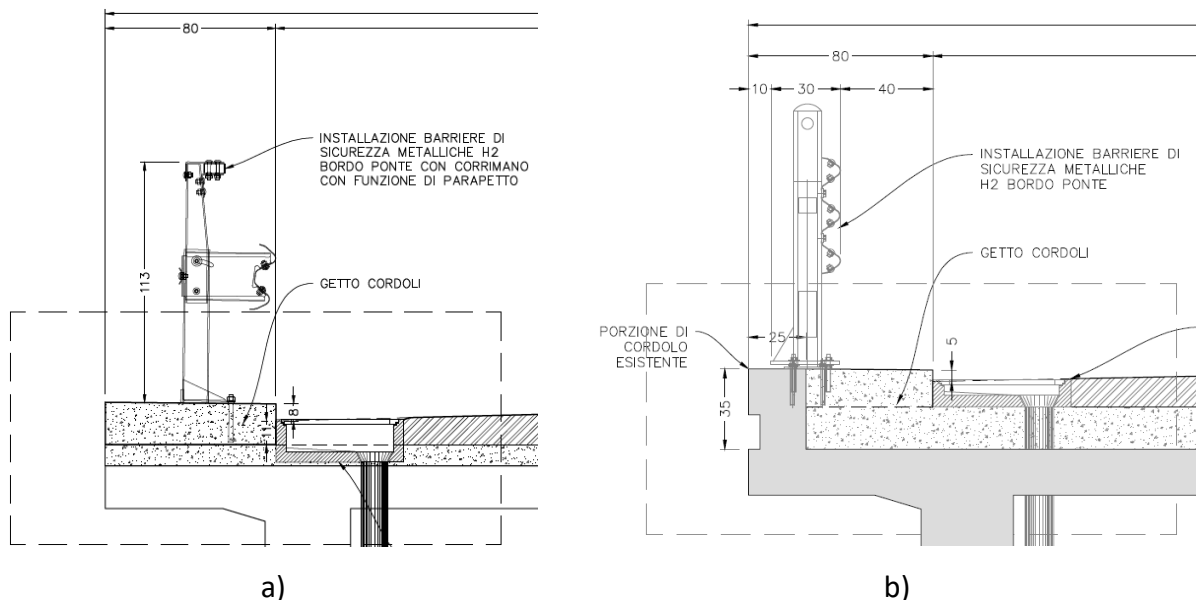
Barriera di sicurezza stradale: a) Progetto Esecutivo b) Barriera e arretramento richiesti dall'Ente Gestore
